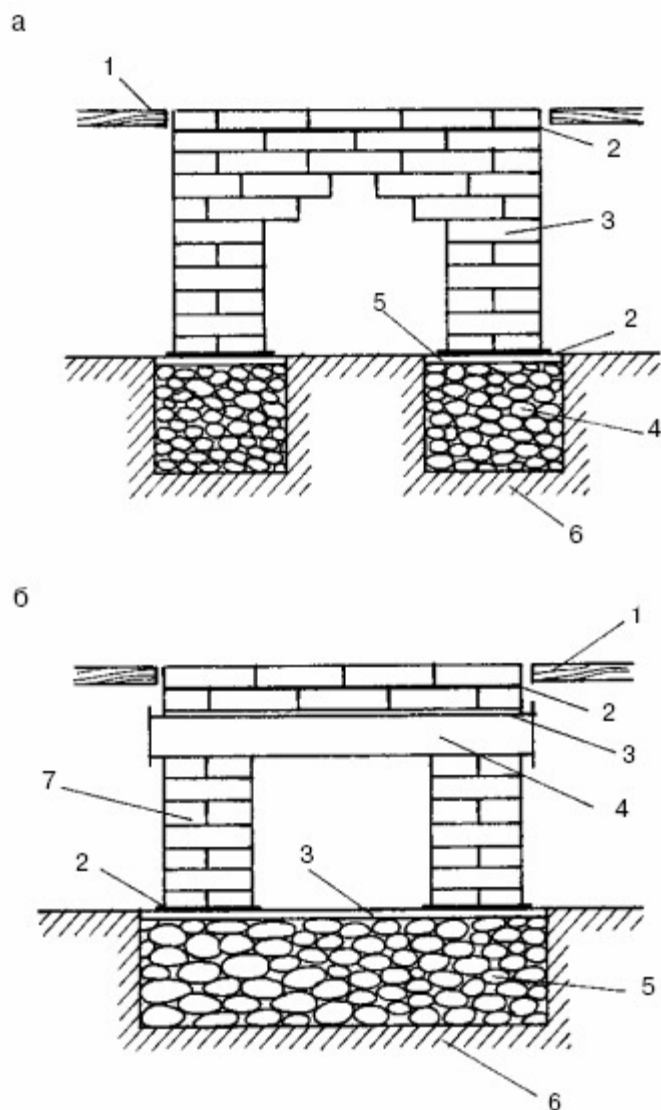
Столбчатый фундамент для печей: а – первый вариант: 1 – пол; 2 – выравнивающий слой; 3 – кладка; 4 – кирпичный щебень и гравий; 5 – гидроизоляция; 6 – грунт; б – второй вариант: 1 – пол; 2 – гидроизоляция; 3 – выравнивающий слой; 4 – железобетонные перемычки или плита; 5 – фундамент в грунте из бутового камня и щебня; 6 – грунт; 7 – столбики из кирпичной кладки
